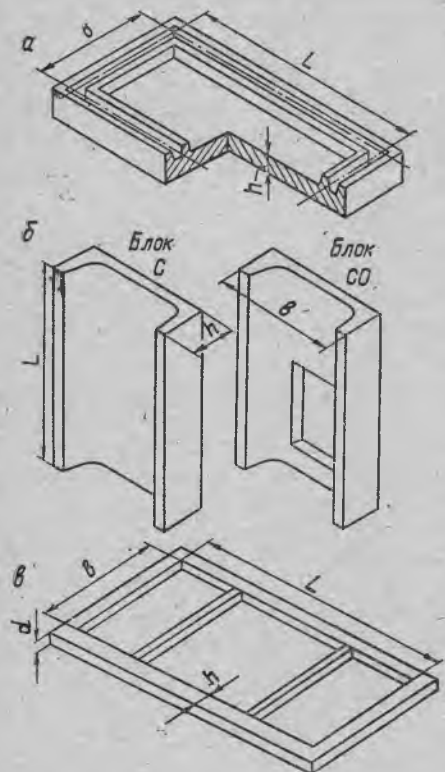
Железобетонные детали подземной части здания насосной станции:
